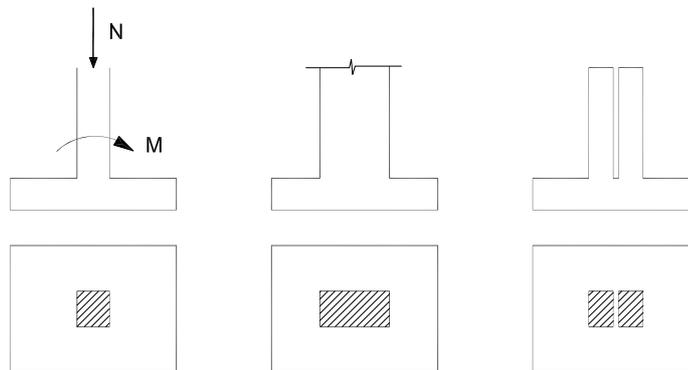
Ejemplos de zapatas aisladas rectangulares
